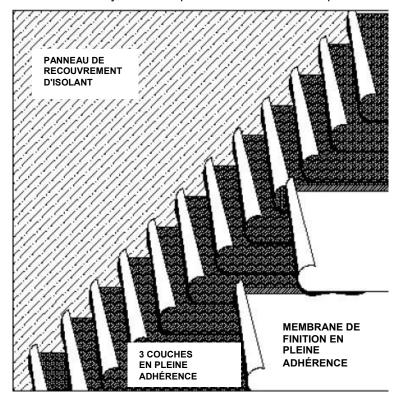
Détail de l'installation d'un système de toiture multicouche
